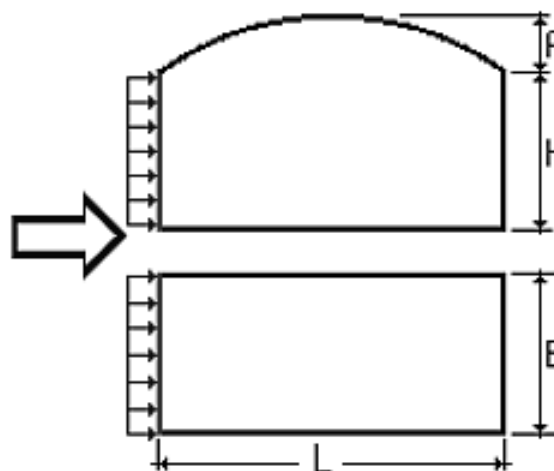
Схема будівлі з напрямком вітрового впливу
